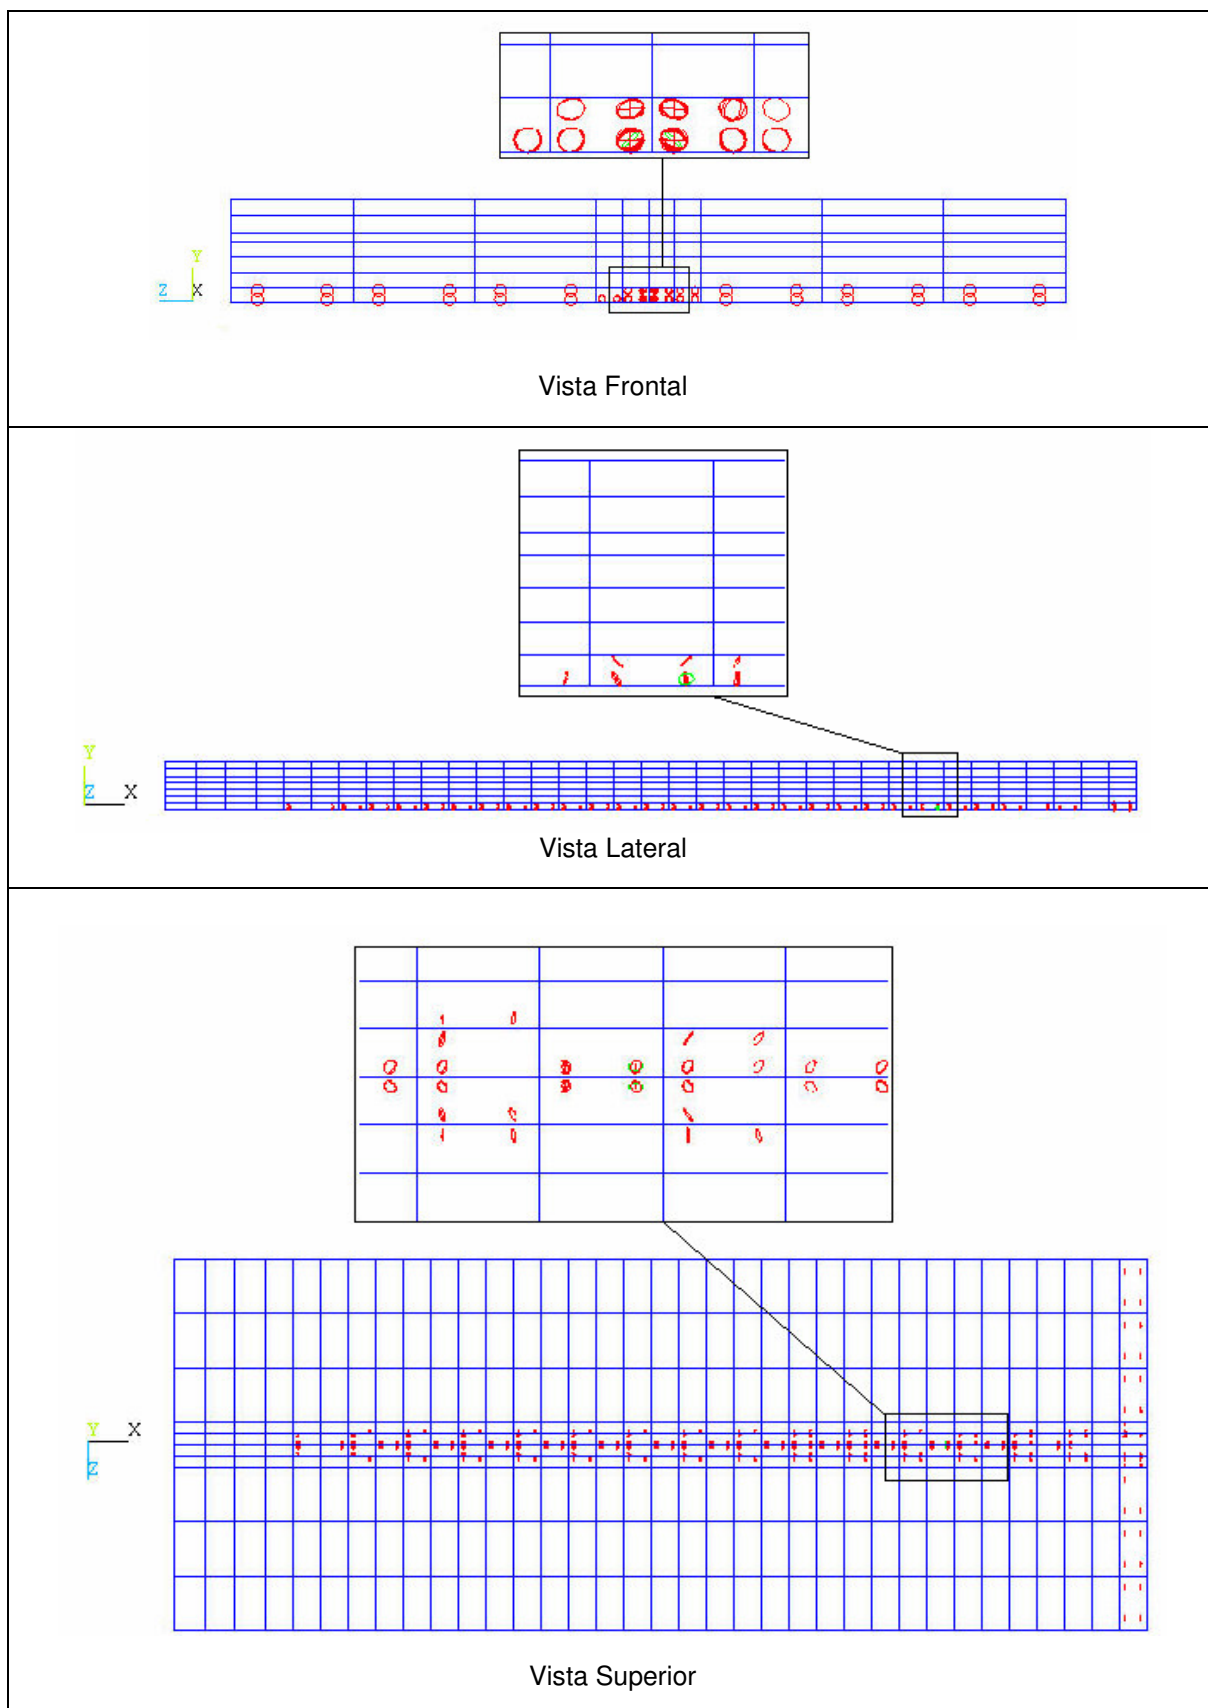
FISSURAS TRANSVERSAIS (DIREÇÃO Z), POR FENDILHAMENTO E POR CISCALHAMENTO NA LAJE DA VIGA A3 – CARGA DE 134,72 KN
